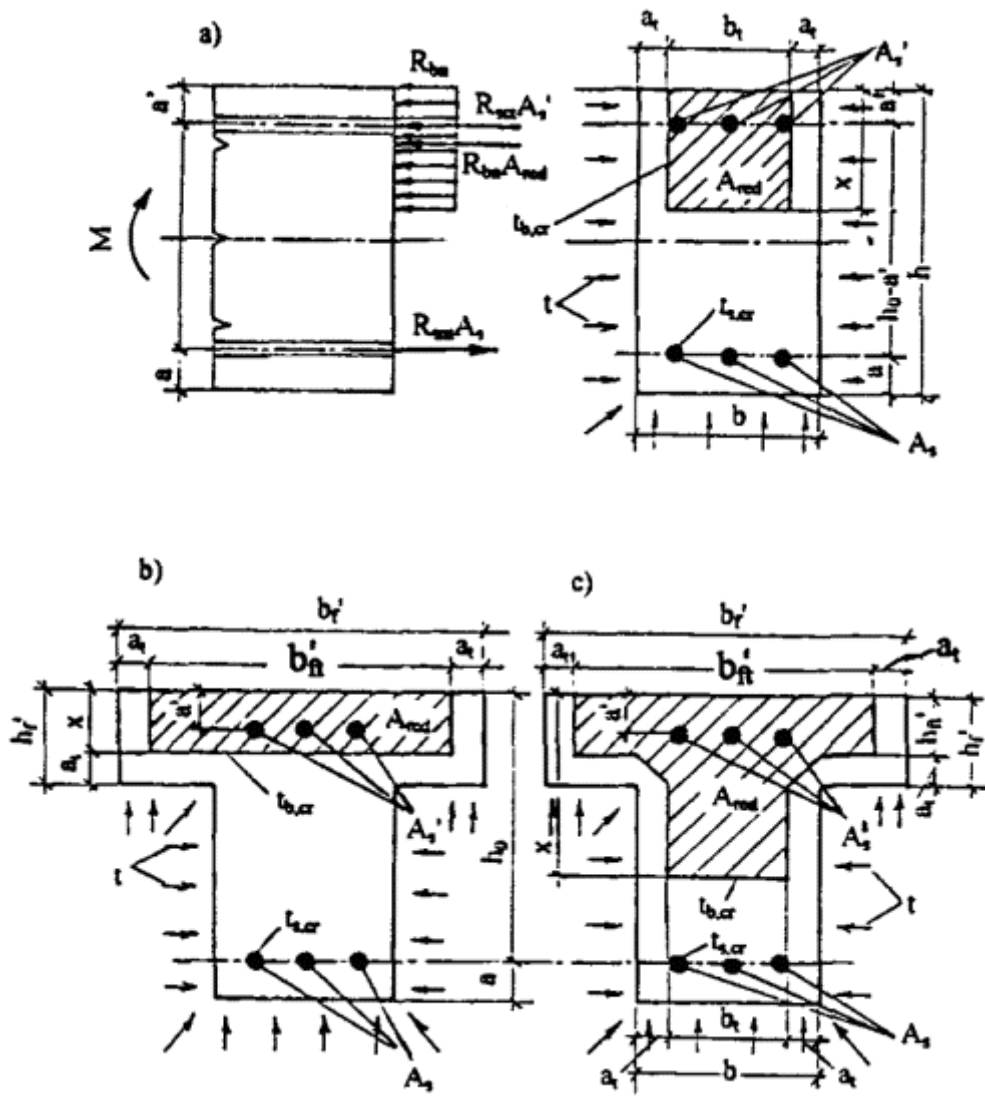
Схема усилий и эпюра напряжений в сечении, нормальном к продольной оси изгибаемого железобетонного элемента при пожаре, обогреваемого с трех сторон, при расчете на огнестойкость:
